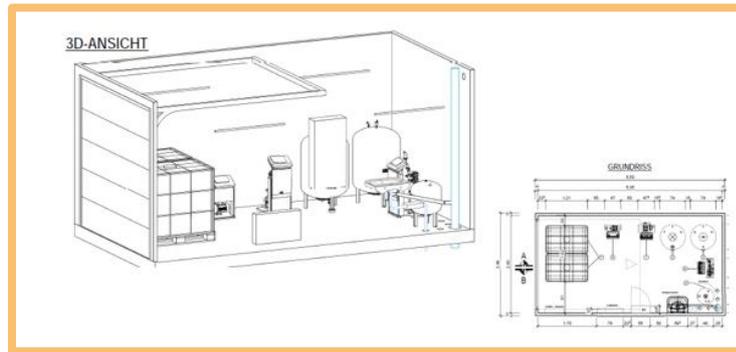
Heizzentrale 3 D-Ansicht und Grundriss – warme Nahwärme
